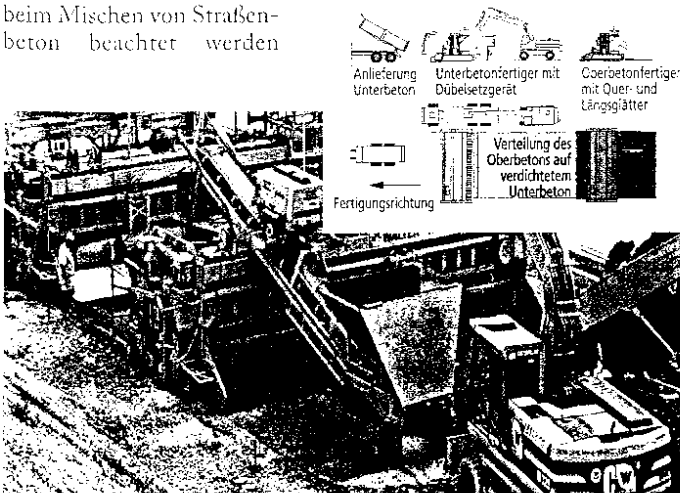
Walter-Heilit-Betondeckeneinbauzug der neuesten Generation im ISO-Seecontainerformat für den zweilagigen bzw. zweischichtigen, mechanisierten Einbau von Verkehrsflächen aus Beton – bestehend aus Ober- und Unterbetonfertiger sowie einer Arbeitsbühne
